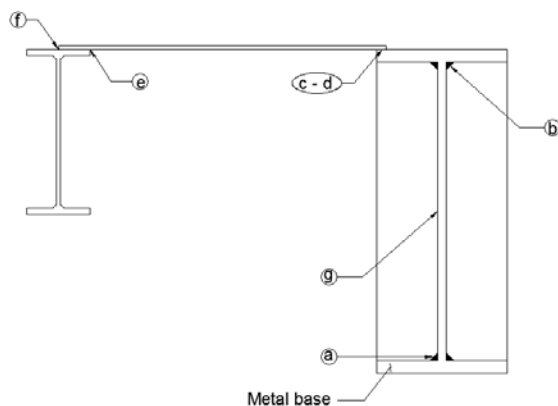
Sección equivalente de la trabe carril con la placa de respaldo y la viga secundaria
